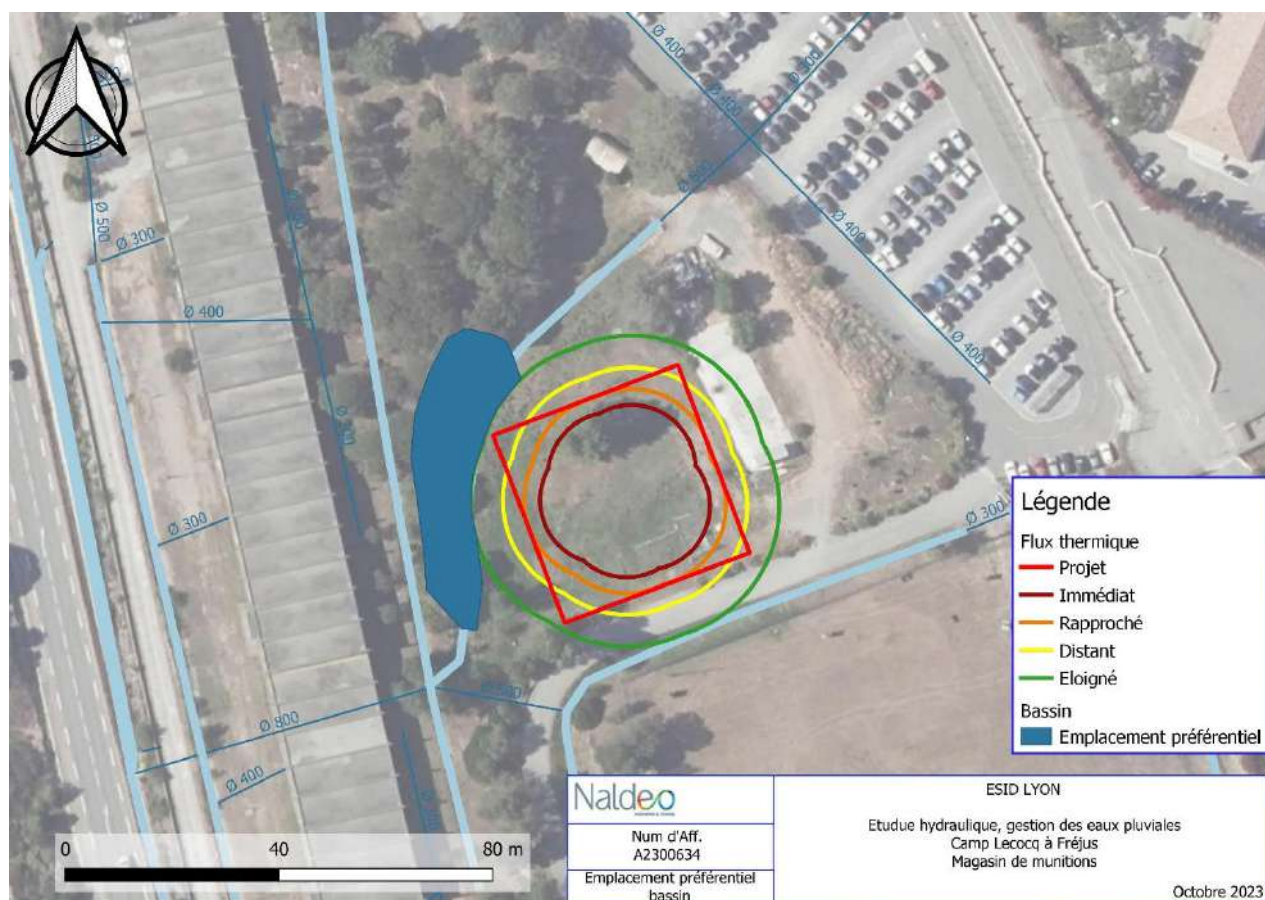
Zone d'implantation préférentielle d'un ouvrage de gestion des eaux pluviales
